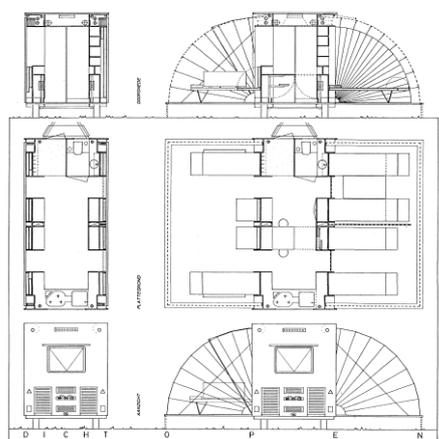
Sezione, pianta e prospetto dell'unità abitativa nelle due versioni: chiusa e aperta.
